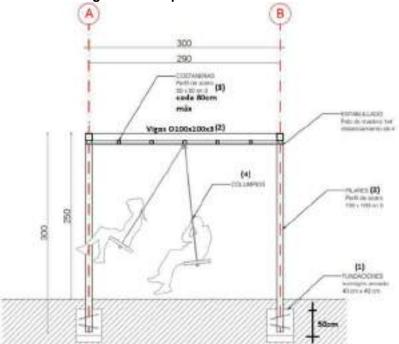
Escantillón Sombreadero - Notas en pie de imagen.
